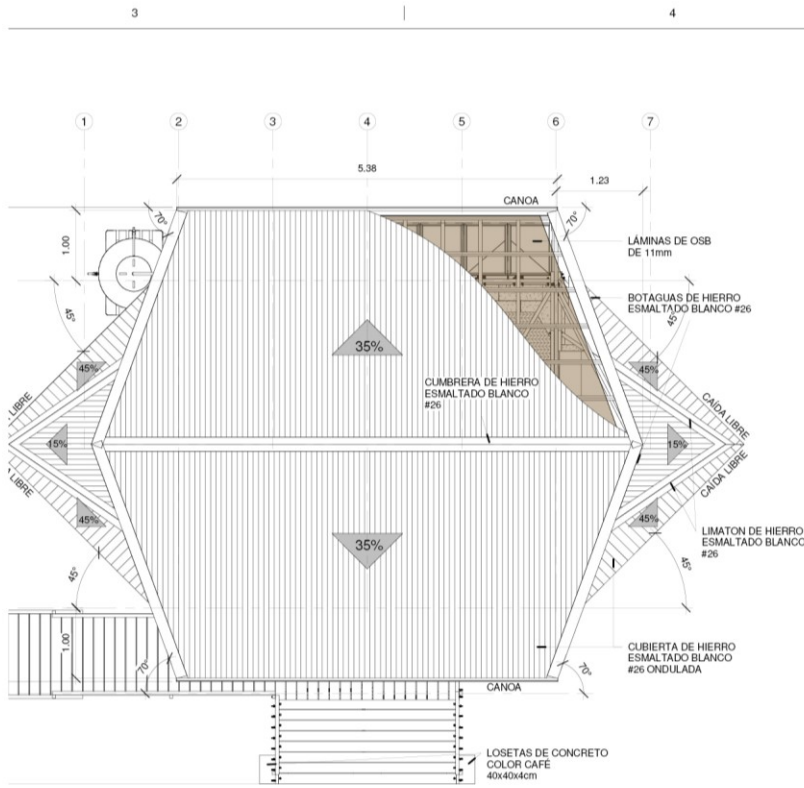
Lámina 01, planimetría de tipología A.<sup>300</sup>
